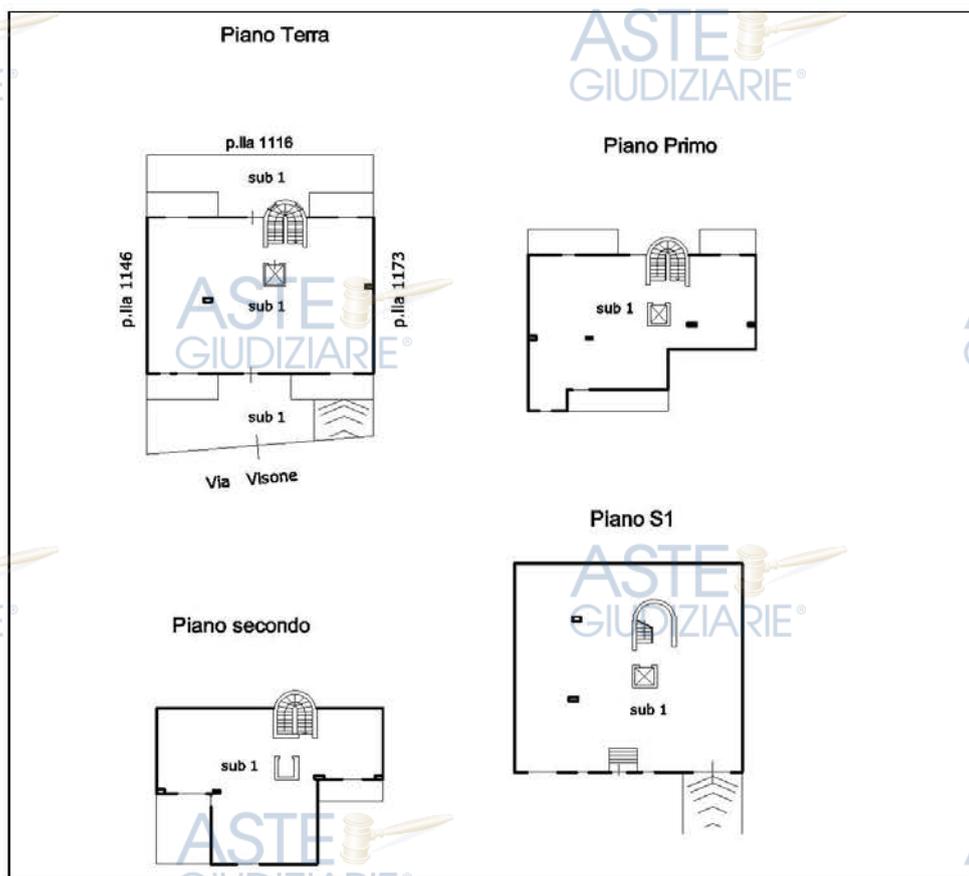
Elaborato planimetrico sub 1 del 30/07/2015
